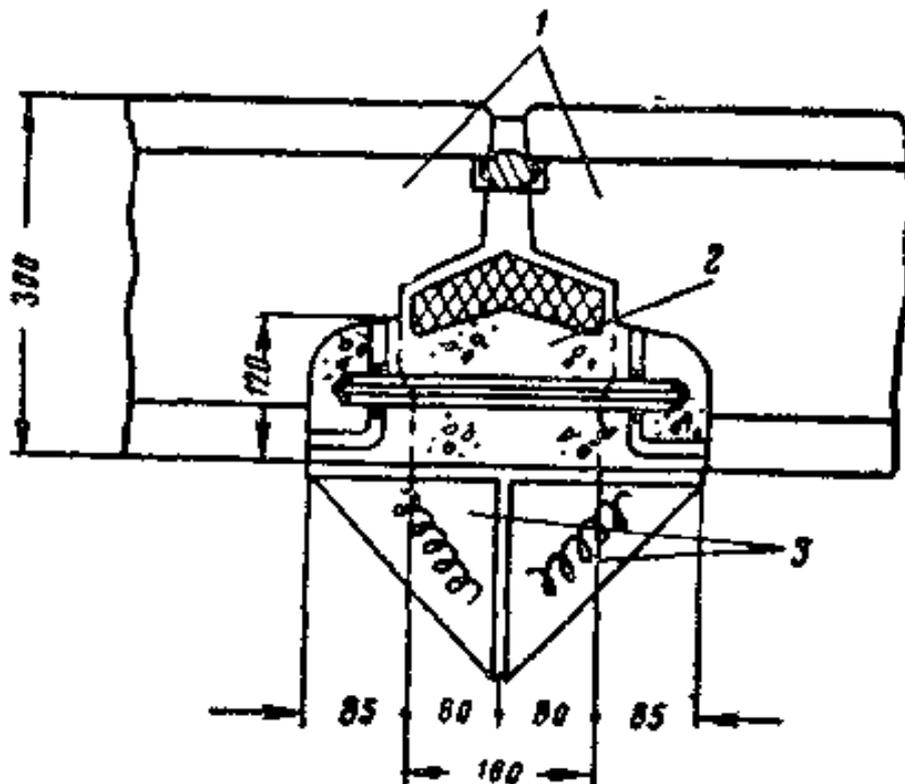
Схема установки греющей опалубки в стыке панелей наружных стен
